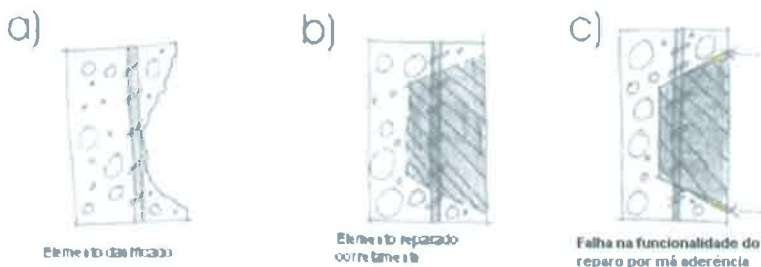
Perda de desempenho do reparo por fissuração na união do concreto novo com o concreto velho.
